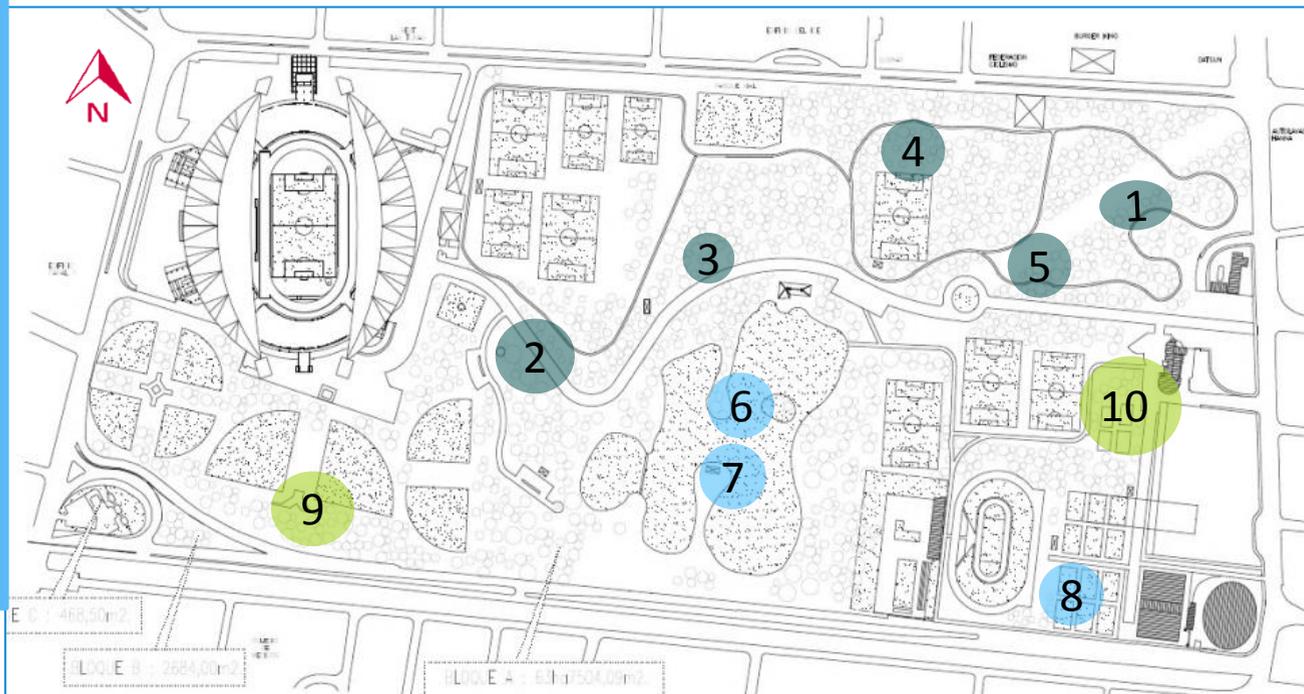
Ubicación preliminar proyectos del plan maestro
